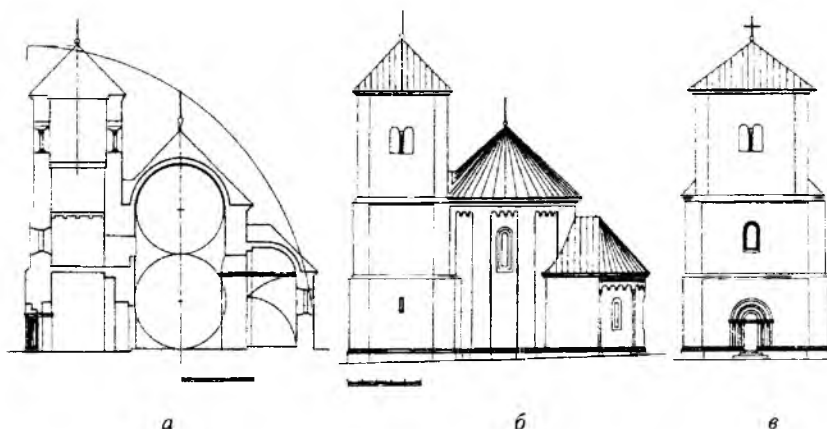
Варіант об'ємно-просторової реконструкції ротонди св. Пророка Іллі у Галичі: а – поздовжній перетин; б – південний фасад; в – західний фасад (за Ю. Лукомським та В. Кіналем)
